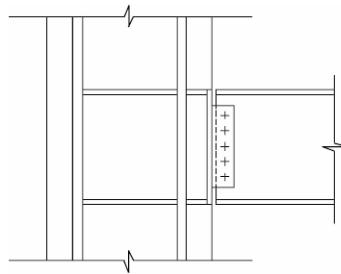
型钢混凝土柱与钢梁铰接连接
